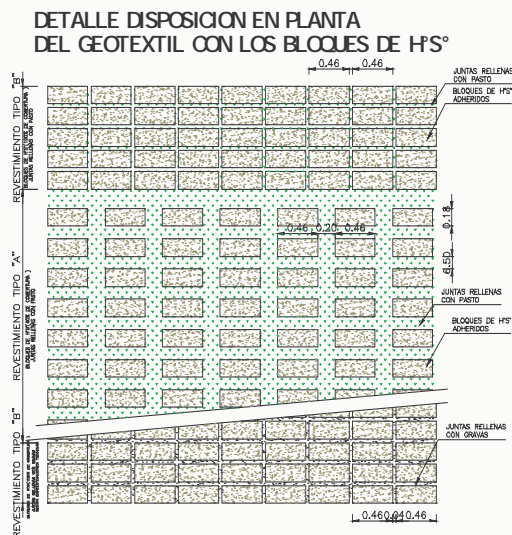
Detalle de disposición en planta del geotextil con los bloques de hormigón simple.
